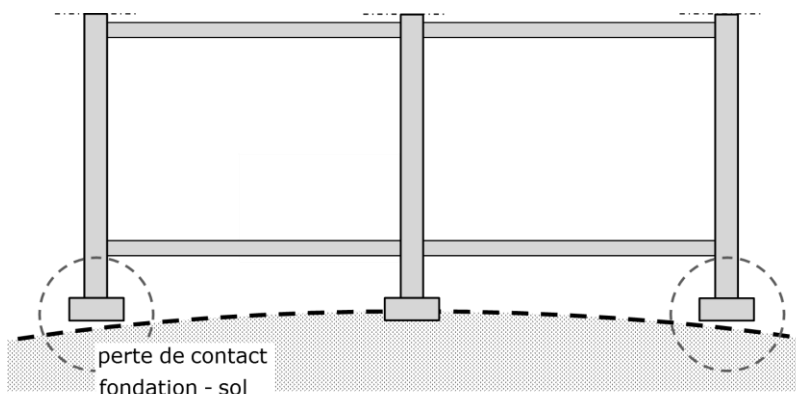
exemple d'une perte d'appui des fondations engendrée par une courbure convexe du terrain
